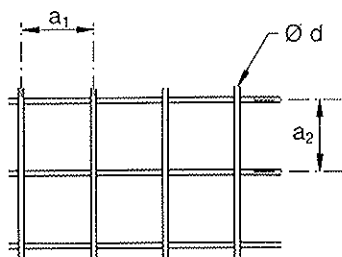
Geschweisste Bewehrungsmatte
